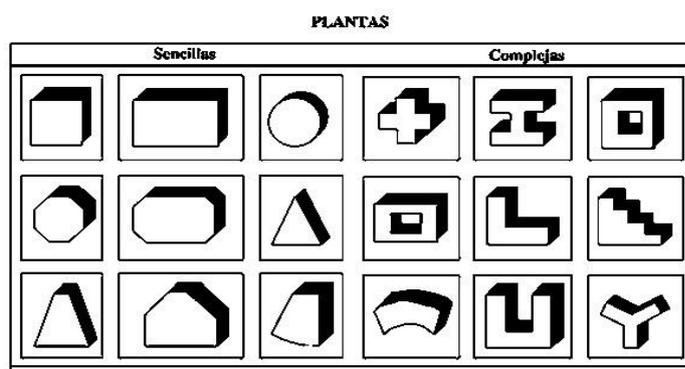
FORMAS SENCILLAS Y COMPLETAS DE PLANTA
